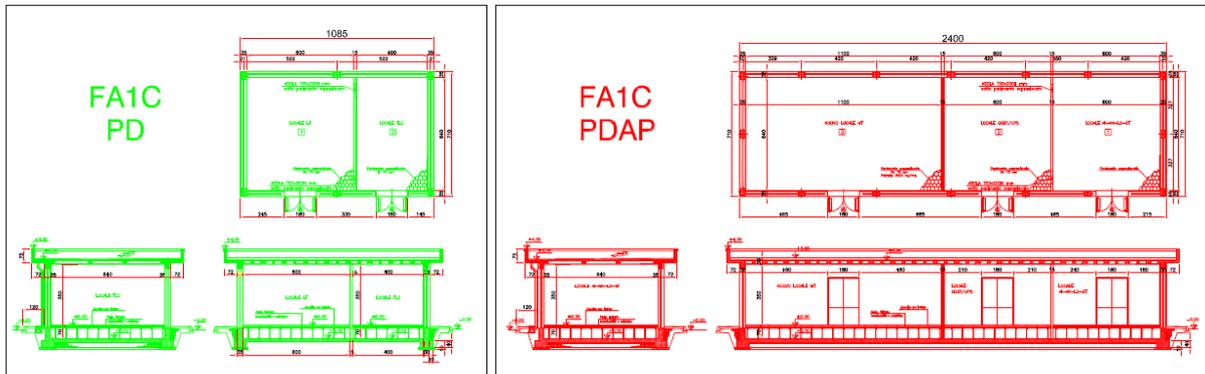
A sinistra planimetria e sezioni della versione PD e a destra la versione PDAP
